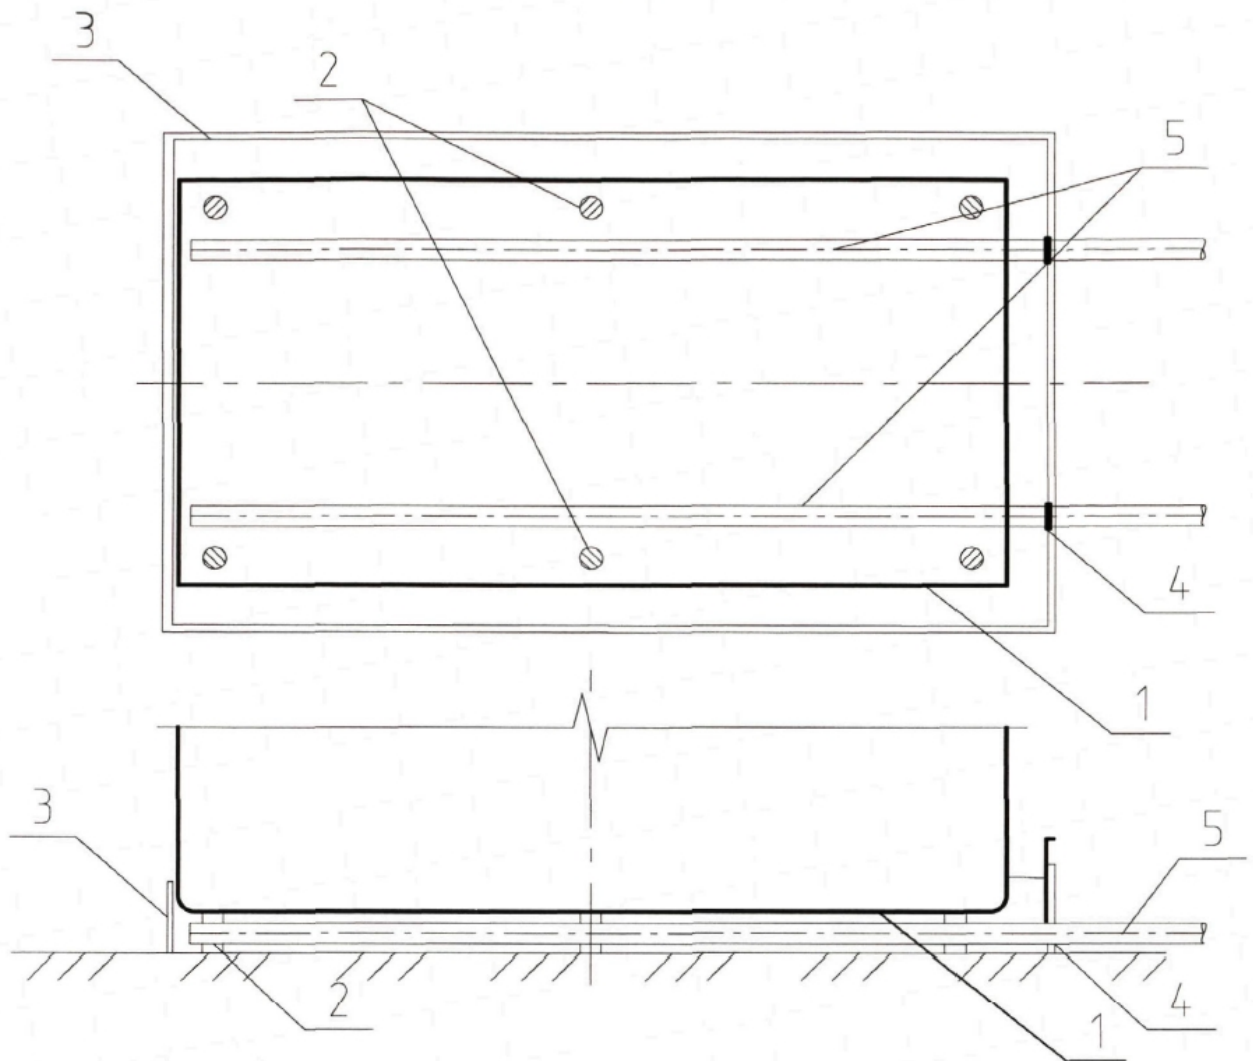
Схема бетонування нагнітаючим методом від торцевої сторони
